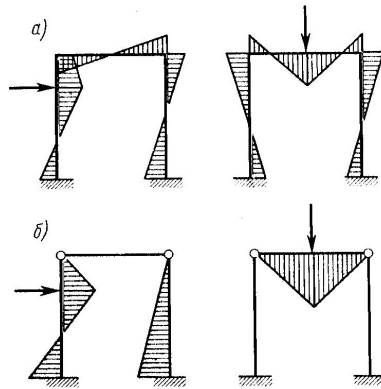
Эпюры моментов в поперечной раме при жестком (а) и шарнирном (б) соединении ригелей с колоннами
